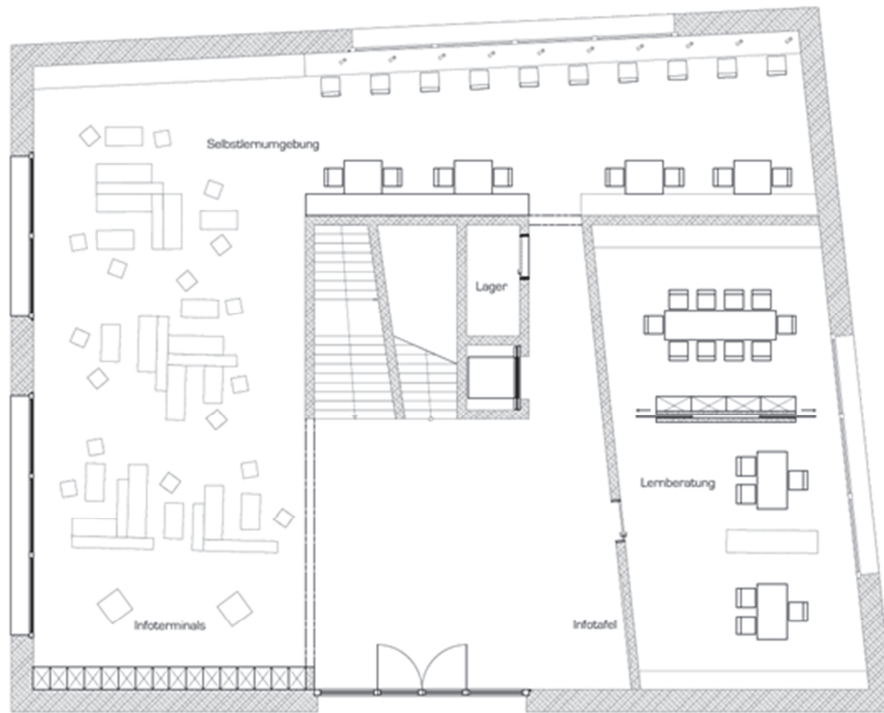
Typ „Zwei Monolithe“: Ausstattung des Selbstlernzentrums im Erdgeschoss
